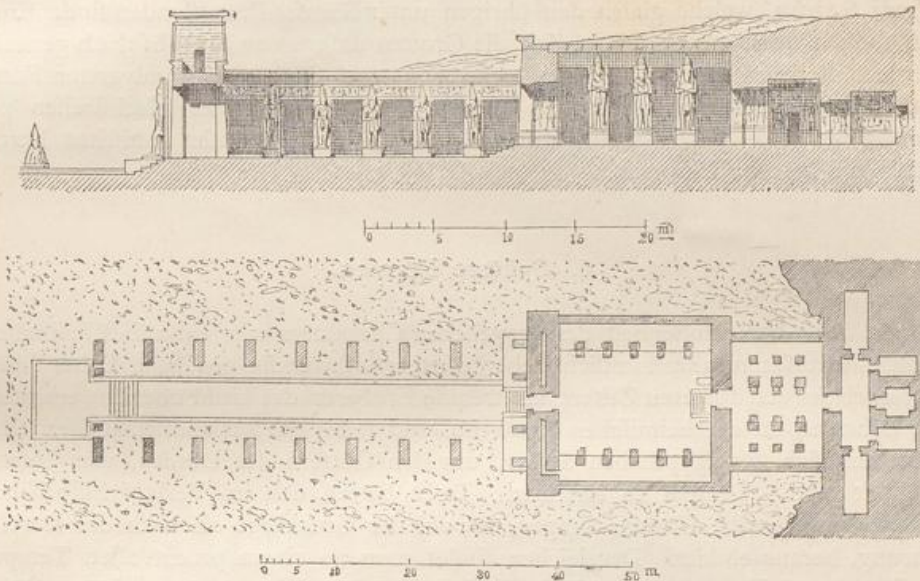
u. 21. Grotte von Girfeh. Grundriss und Längenschnitt. (Chipiez.)
